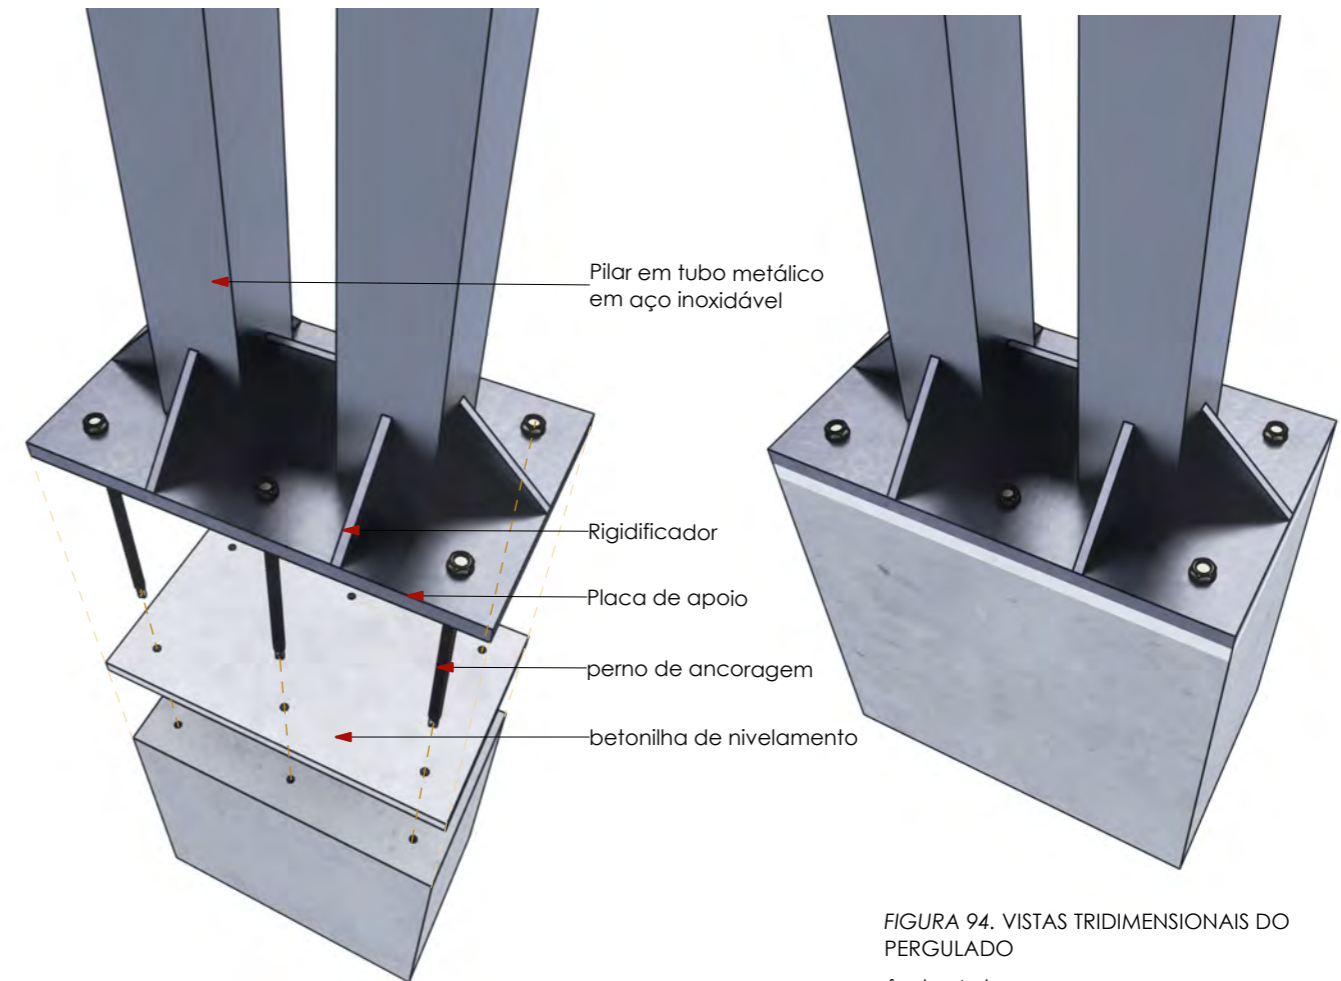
VISTAS TRIDIMENSIONAIS DO PERGULADO
